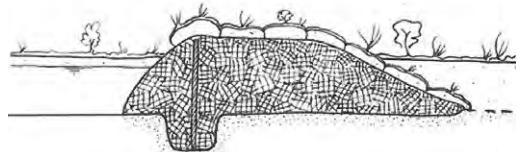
Grabenkammerung im Längsschnitt mit einem ausgebaggerten Querschlag für den Einbau der Holzspundwand (aus: BAFU 2009).
